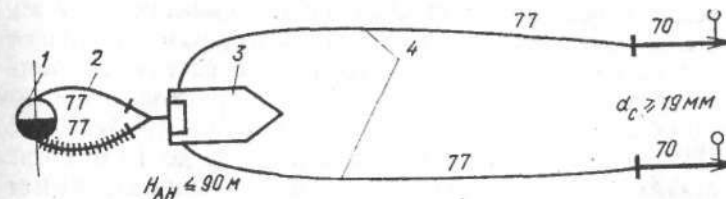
Схема испытания сети отбором воды пожарными автонасосами
